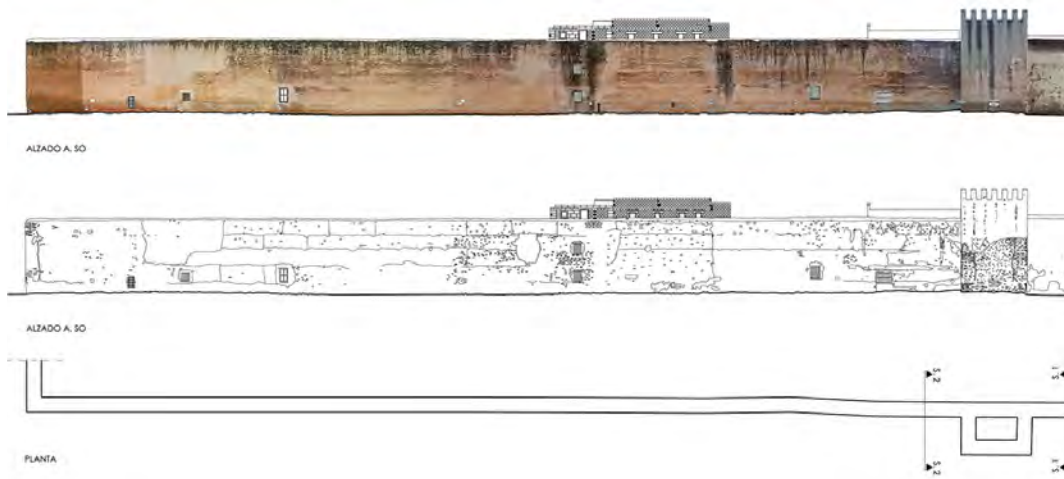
Muralla de Mascarell. Alzado suroeste. Fuente: P. Rodríguez-Navarro y T. Gil Piqueras.
